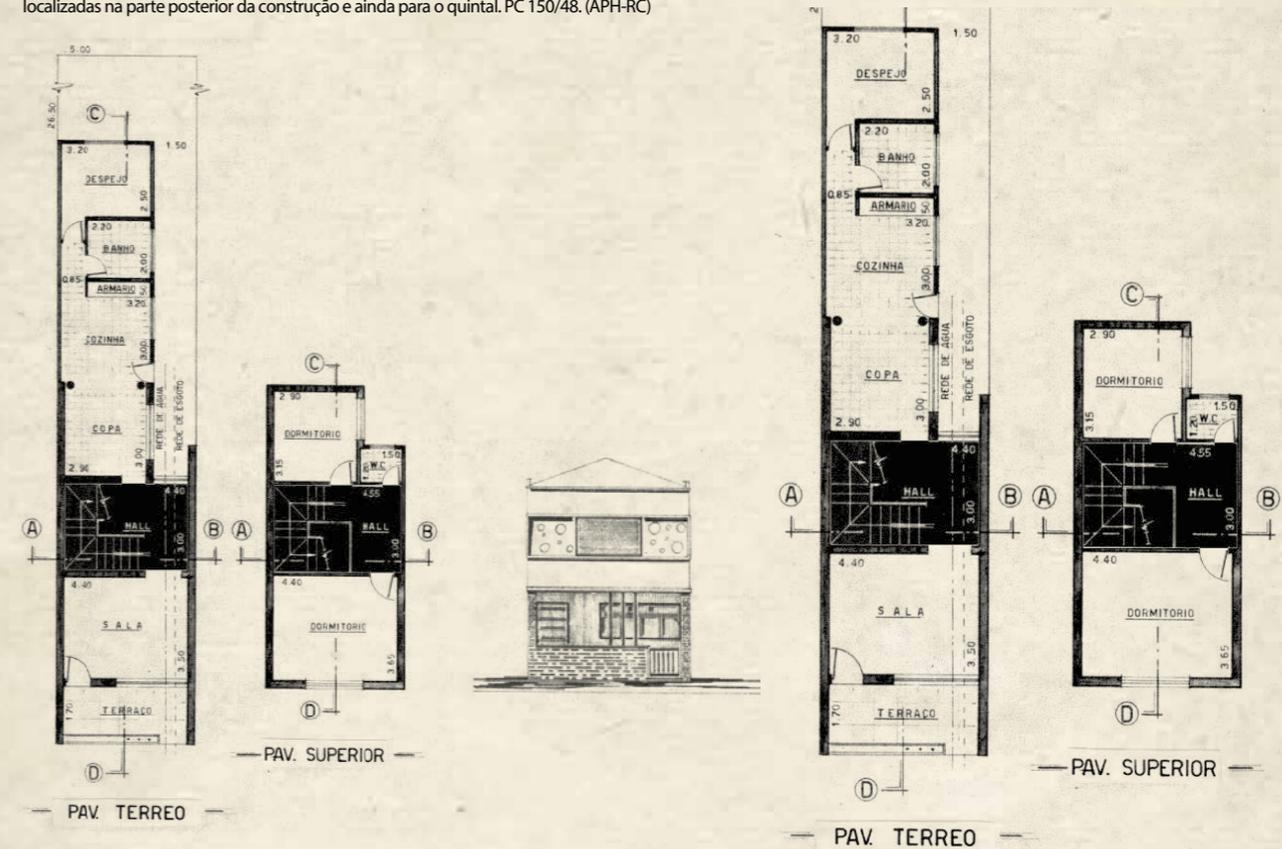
Planta arquitetônica e detalhe. Nas construções residenciais sobradadas, geralmente a escada para o acesso ao pavimento superior estava localizada no vestíbulo ou hall. PC 553/60. (APH-RC)
